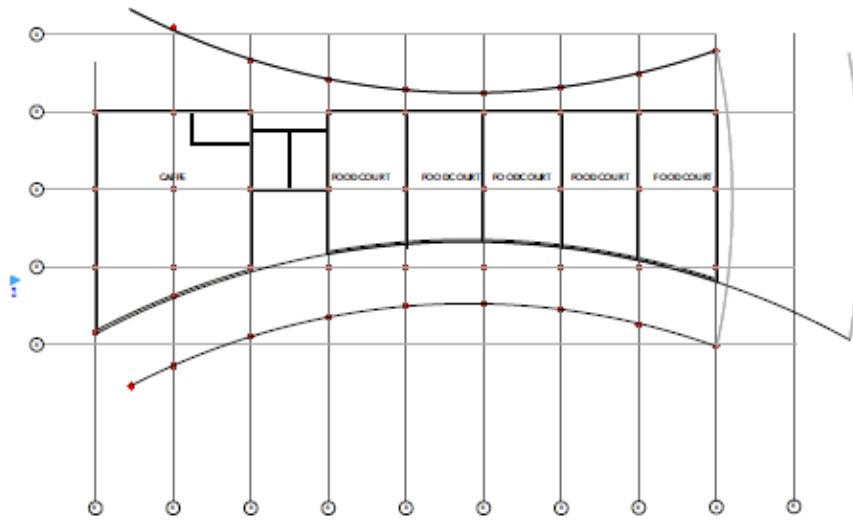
Denah lantai 1 Auditorium dan Expo Hall DMC
